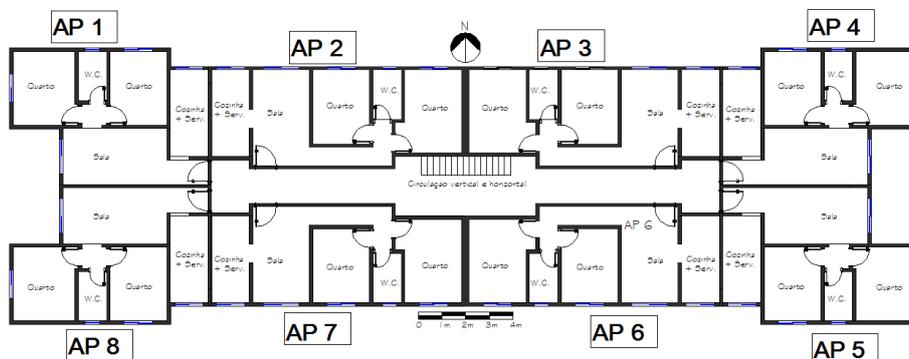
Planta baixa do pavimento tipo do estudo de caso 2
